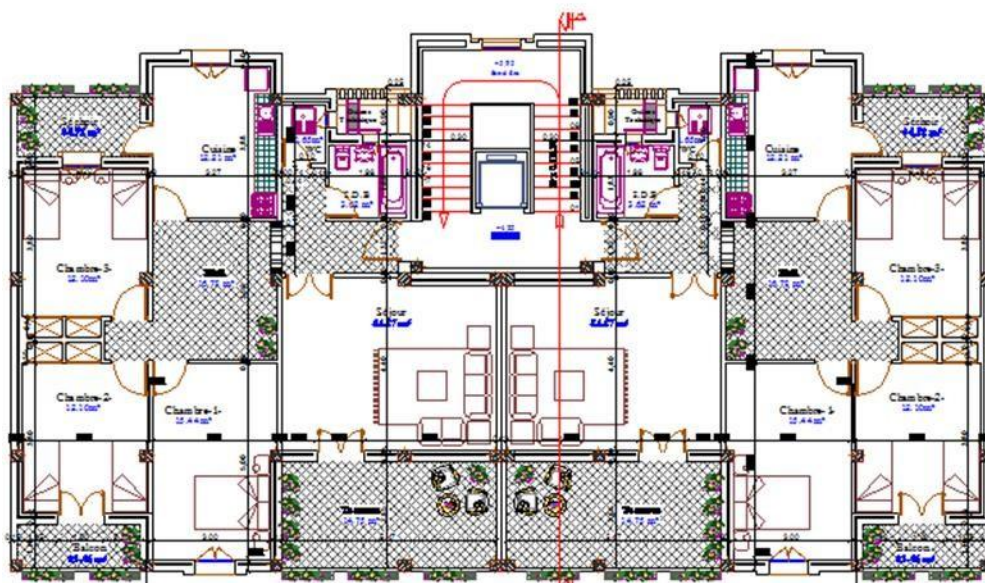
Plan du 1<sup>er</sup> étage, source : auteur
